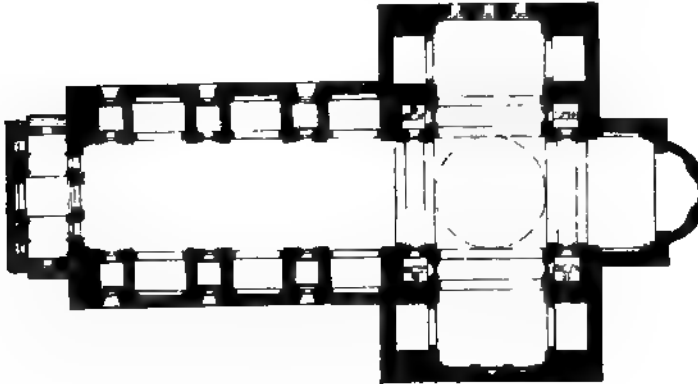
Grundriss von S. Andrea zu Mantua
